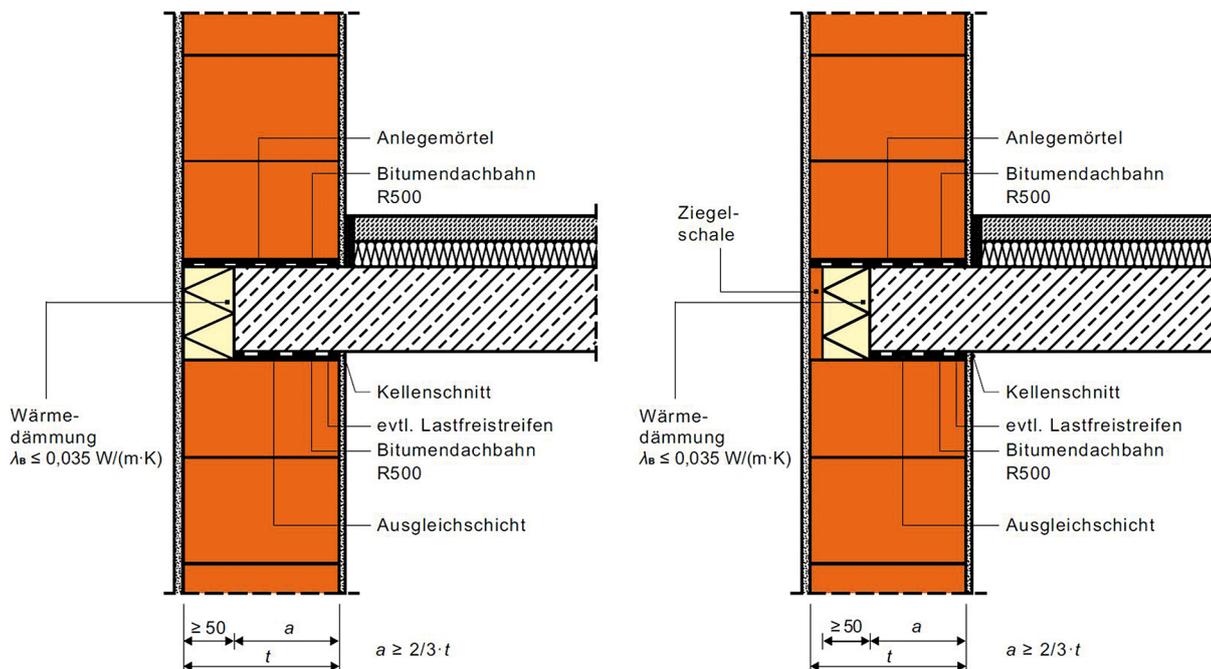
Ausführungsvarianten eines Außenwand-Decken-Knotens mit monolithischem Ziegelmauerwerk [18]
